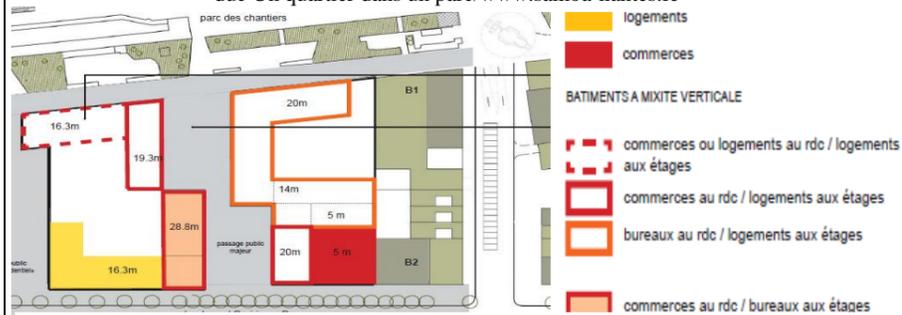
; Plan d'aménagement de l'IPOS (source : faisabilité urbaine et architecturale fin 2011)
